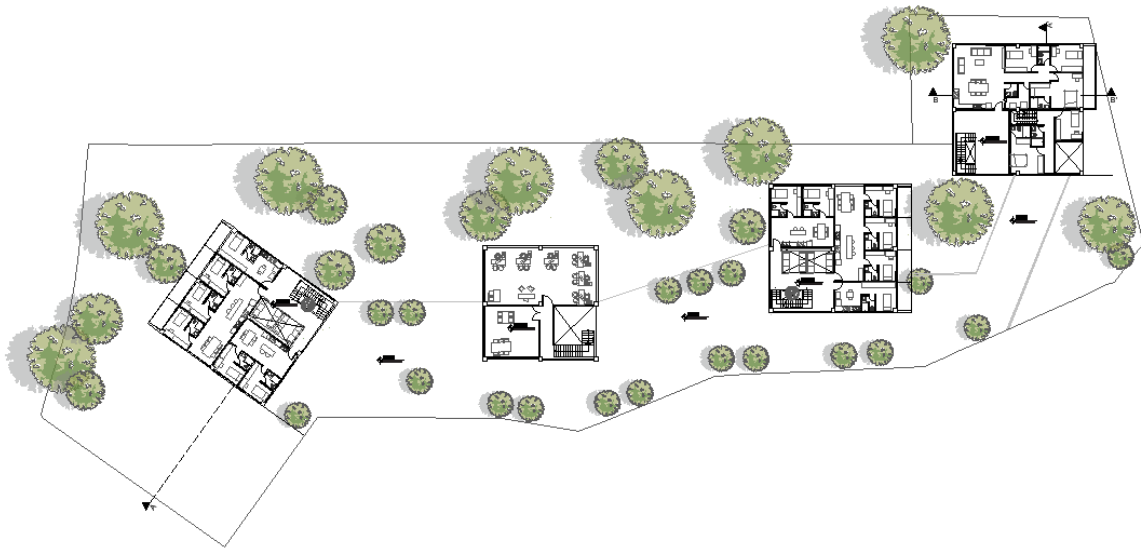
Planta tipo 2 viviendas. Elaboración propia.
